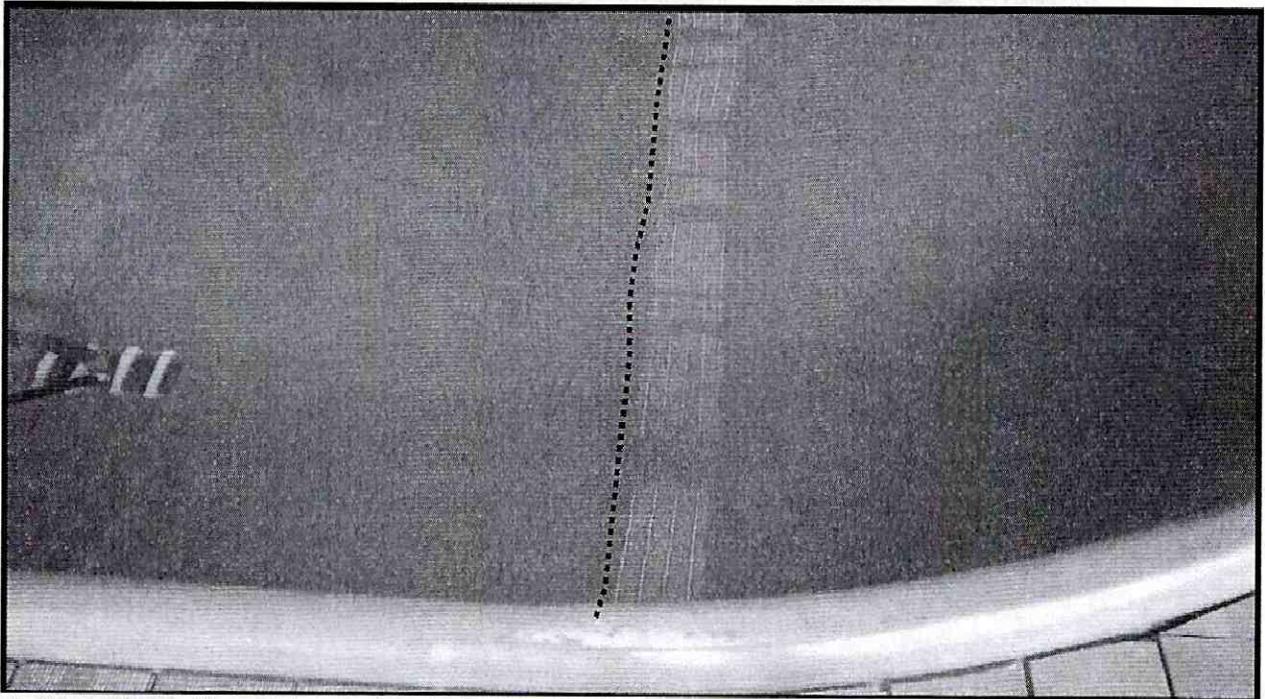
Fisura de tendencia escalonada en el muro junto a la rampa de acceso a los sótanos sobre la Calle 124 en el Conjunto Residencial Provenza Royal
